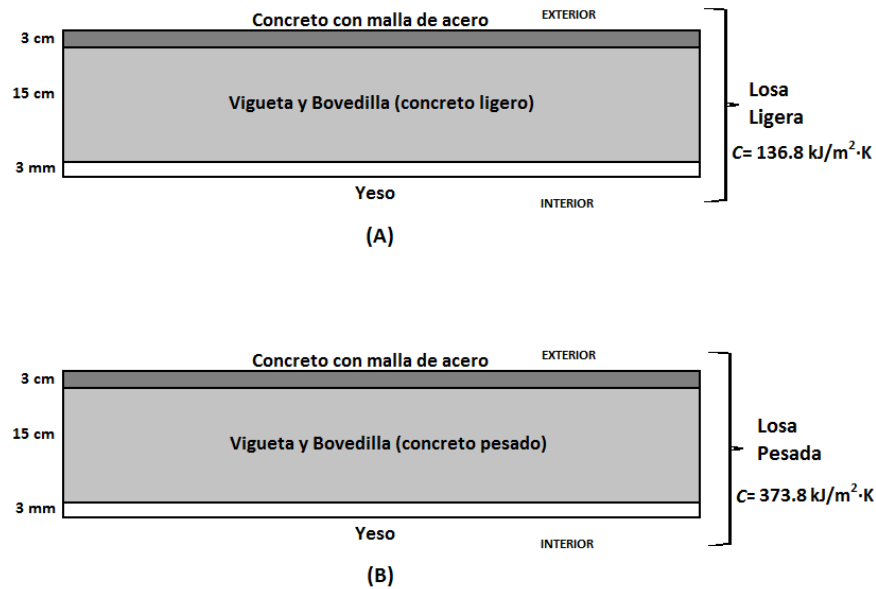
Representación esquemática de los tipos de losas utilizados en el estudio. (A): Losa de bovedilla de concreto “ligero”. (B): Losa de bovedilla de concreto “pesado”.
